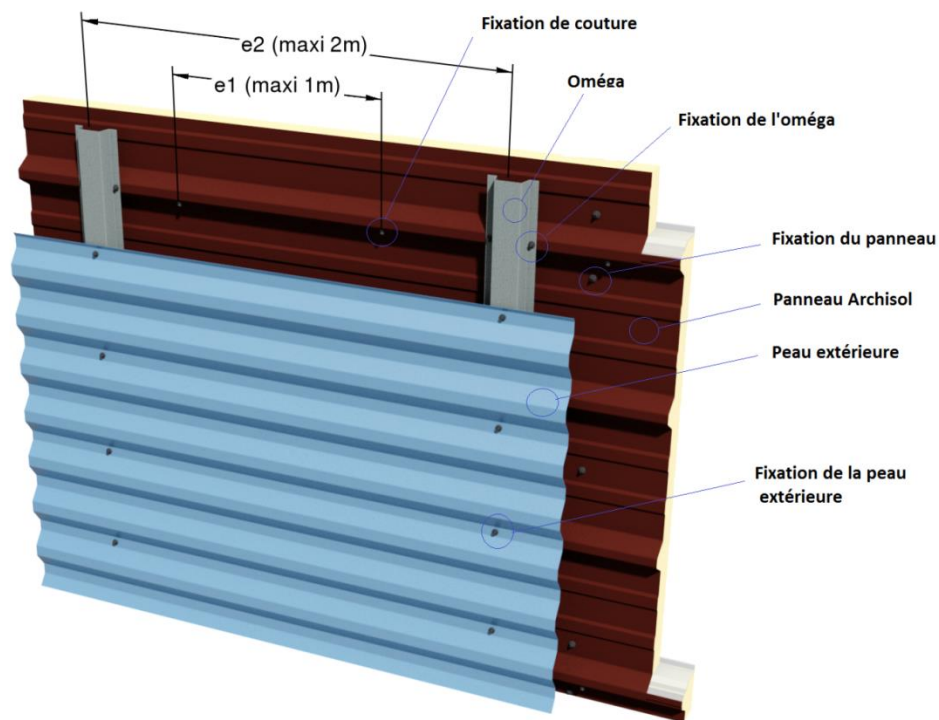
Vue 3D - Dessin de principe – panneau horizontal, ossature en simple réseau
